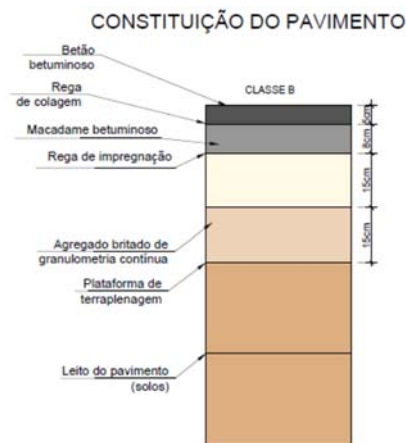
Estrutura do pavimento do restabelecimento 2A
